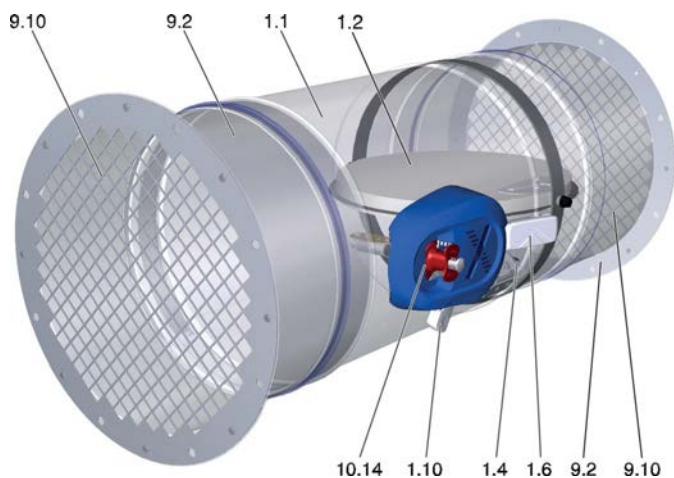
FKR-EU cu legătură fuzibilă și grilă de acoperire ca obturator în amonte pentru unitatea de transfer a aerului (Fig. Construcție cu robinet)
